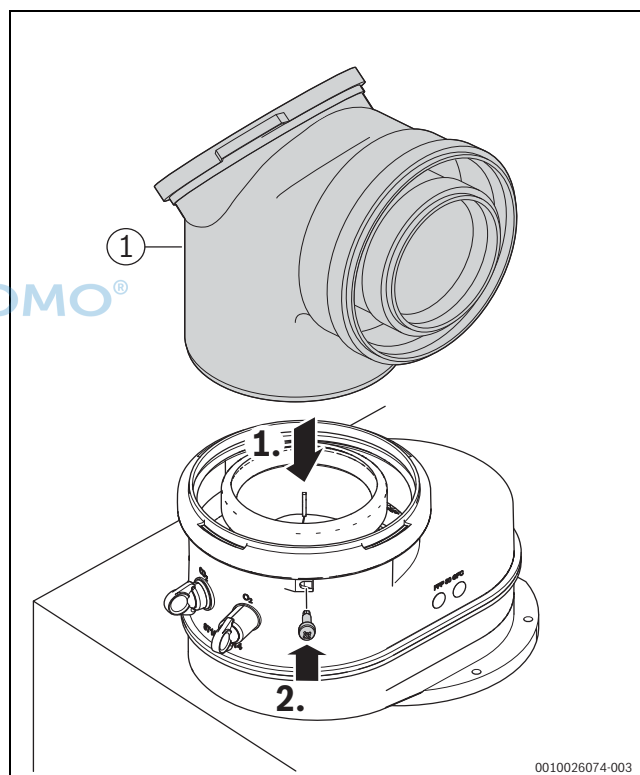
Abgaszubehör einsetzen und mit Schraube sichern
